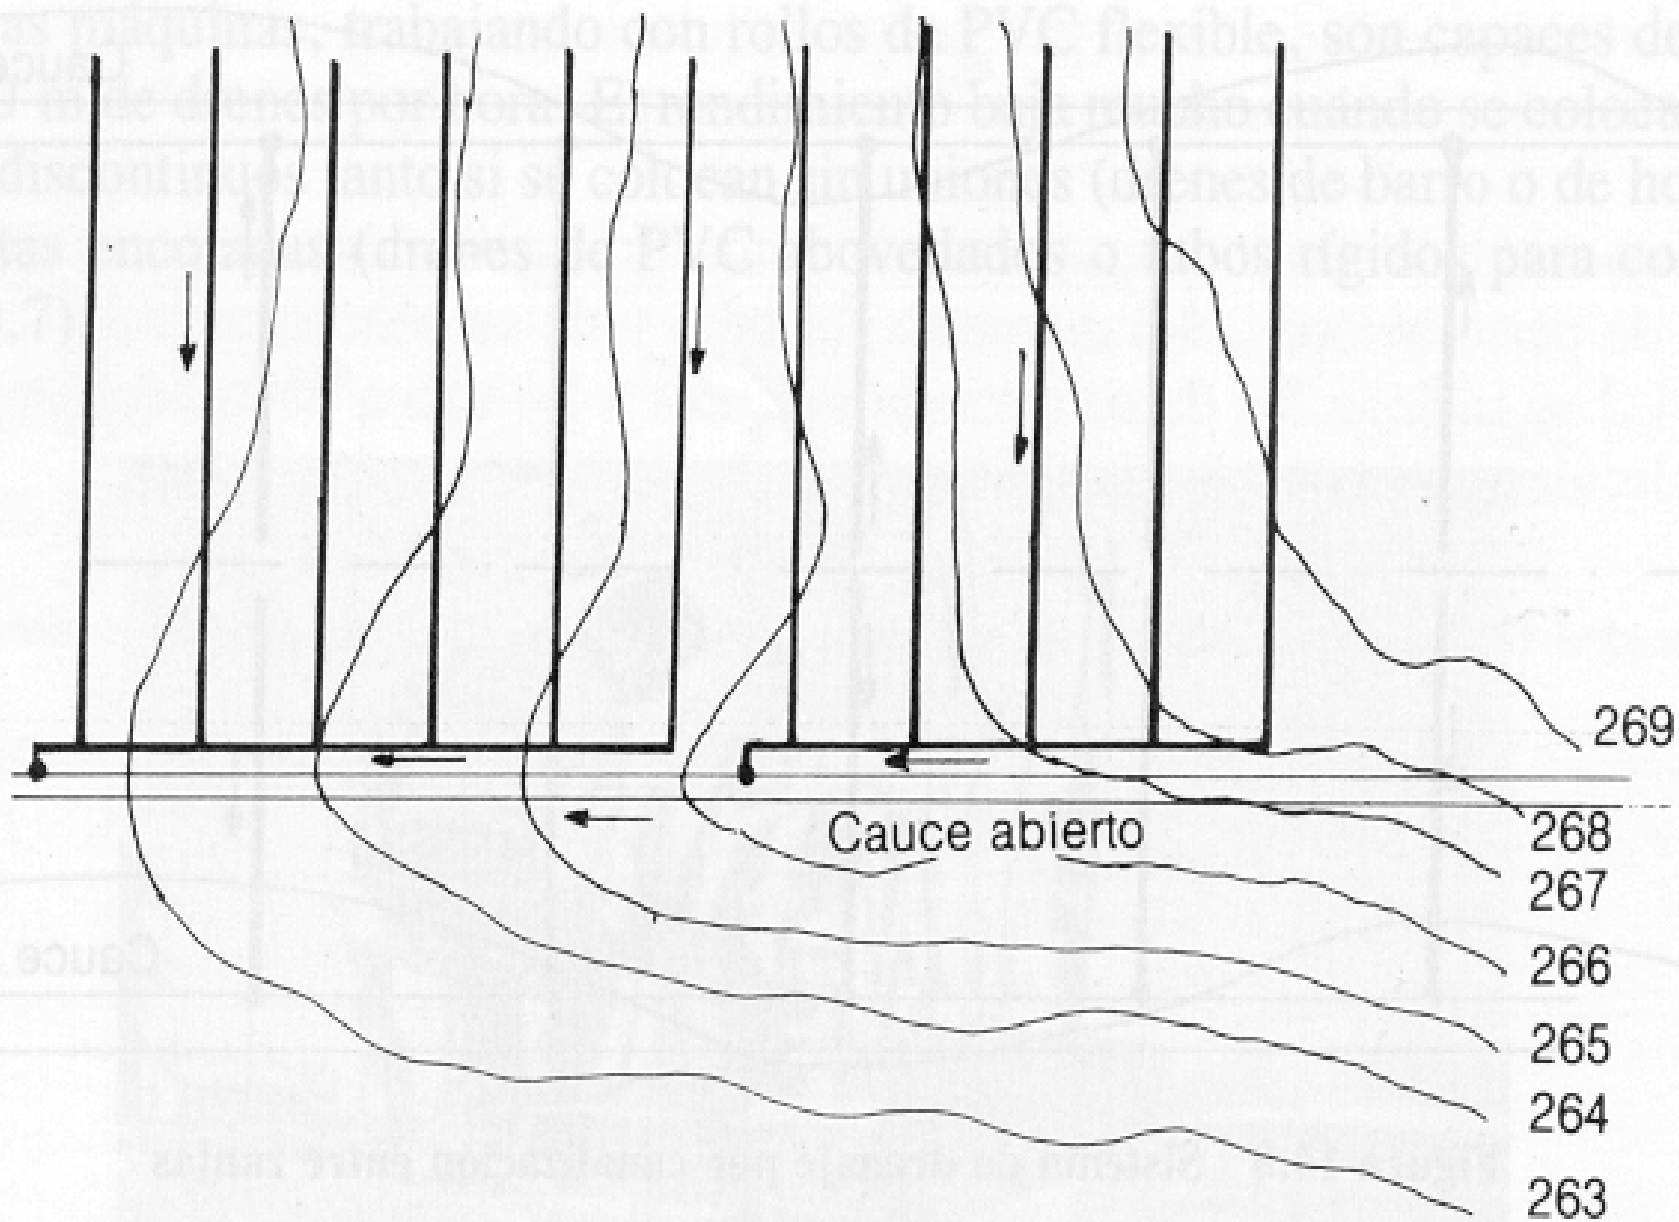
Sistema de drenaje por drenes paralelos descendentes
